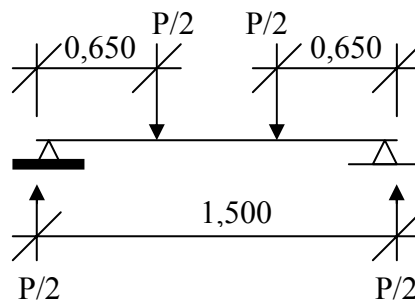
Detalhe do carregamento da laje (medidas em metros)
